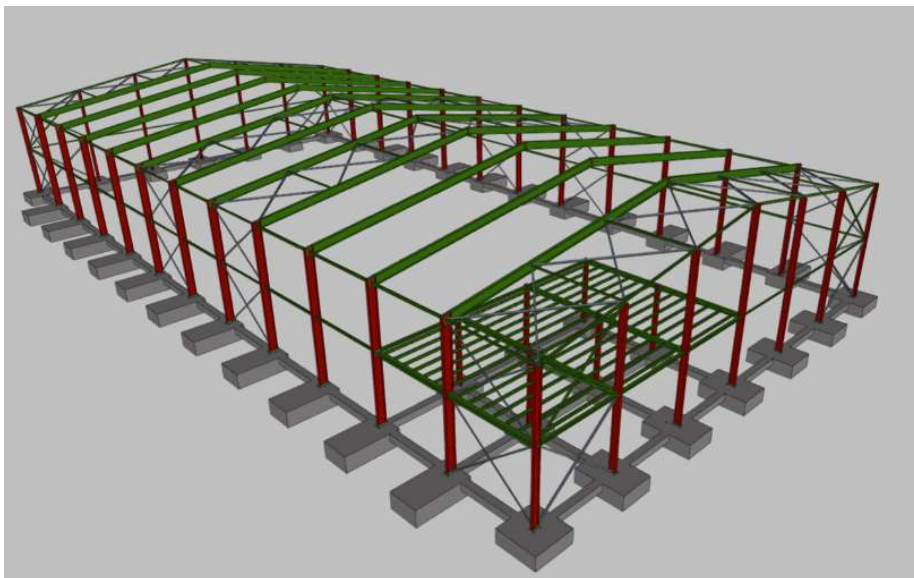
Vista 3D de la estructura. (Fuente CYPE 3D).
